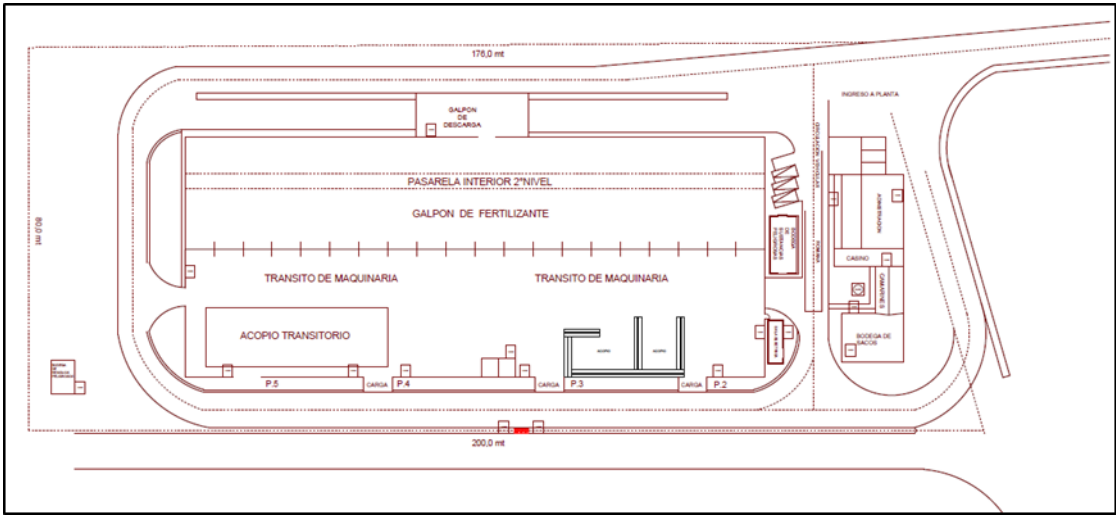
Plano de la planta IANSA FERT, Cosmito
